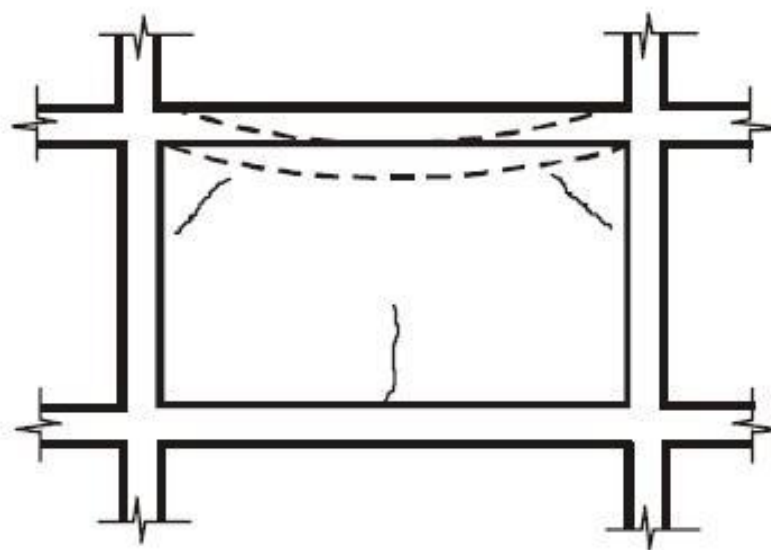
fissuras causadas pela deformação exagerada da viga superior (DUARTE, 1998, p. 13)
